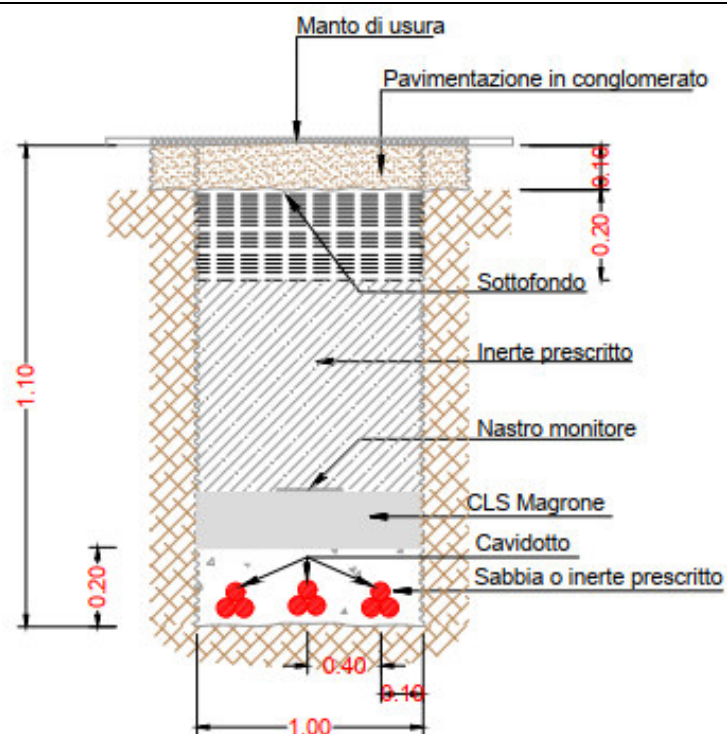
Posa tipo attraversamento strada (da tav. PA-Tav.12.6)
